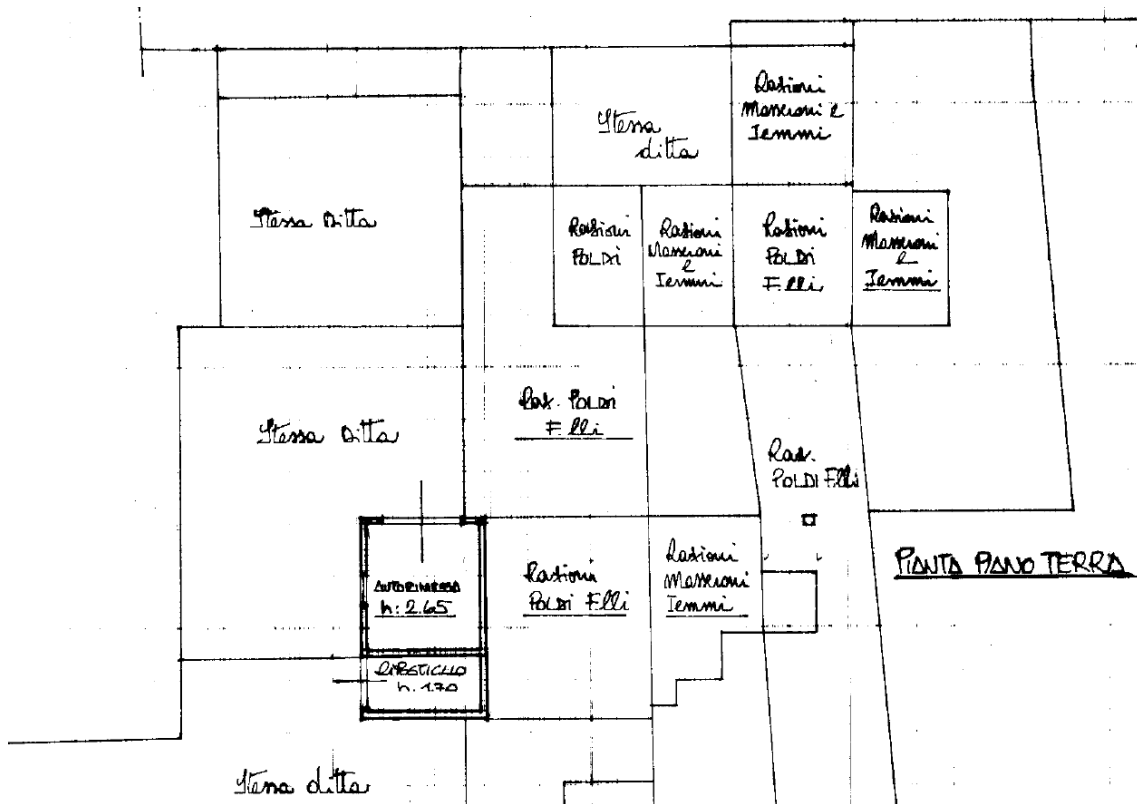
Pianta piano terra - inquadramento da planimetria - fuori scala
